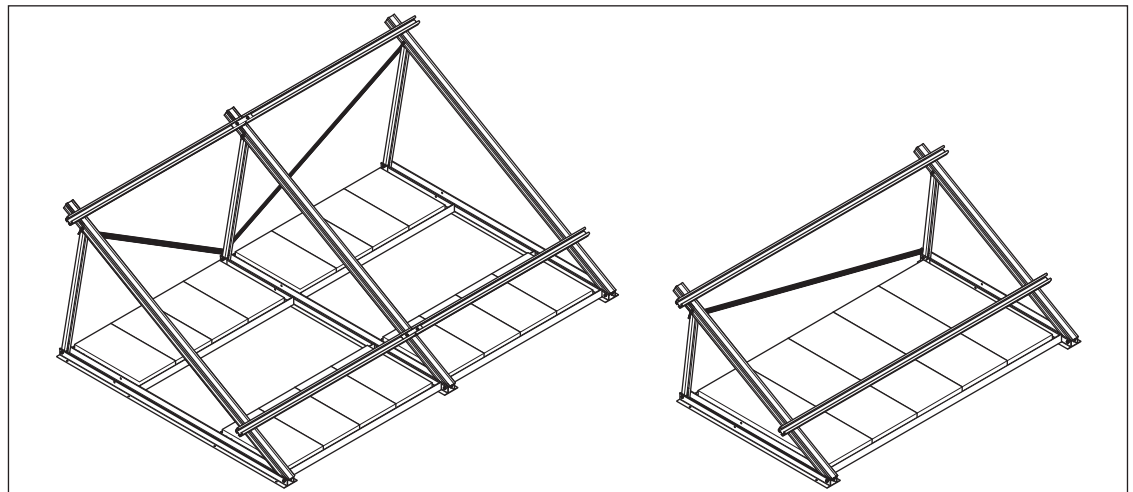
Aseguramiento de la construcción independiente en tejado plano mediante pesos para carga
